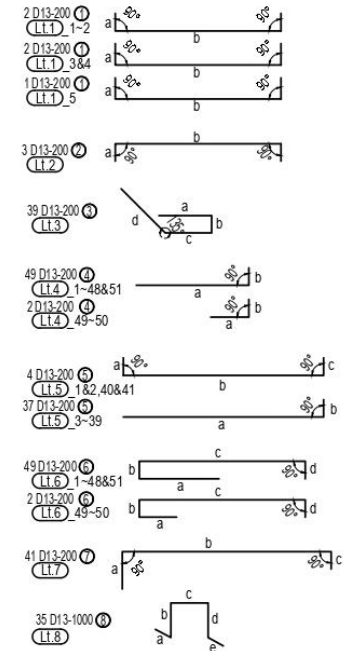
BBS Outlet Spillway Denah Pembesian Lantai Atas dan Lantai Bawah Lantai Tengah
